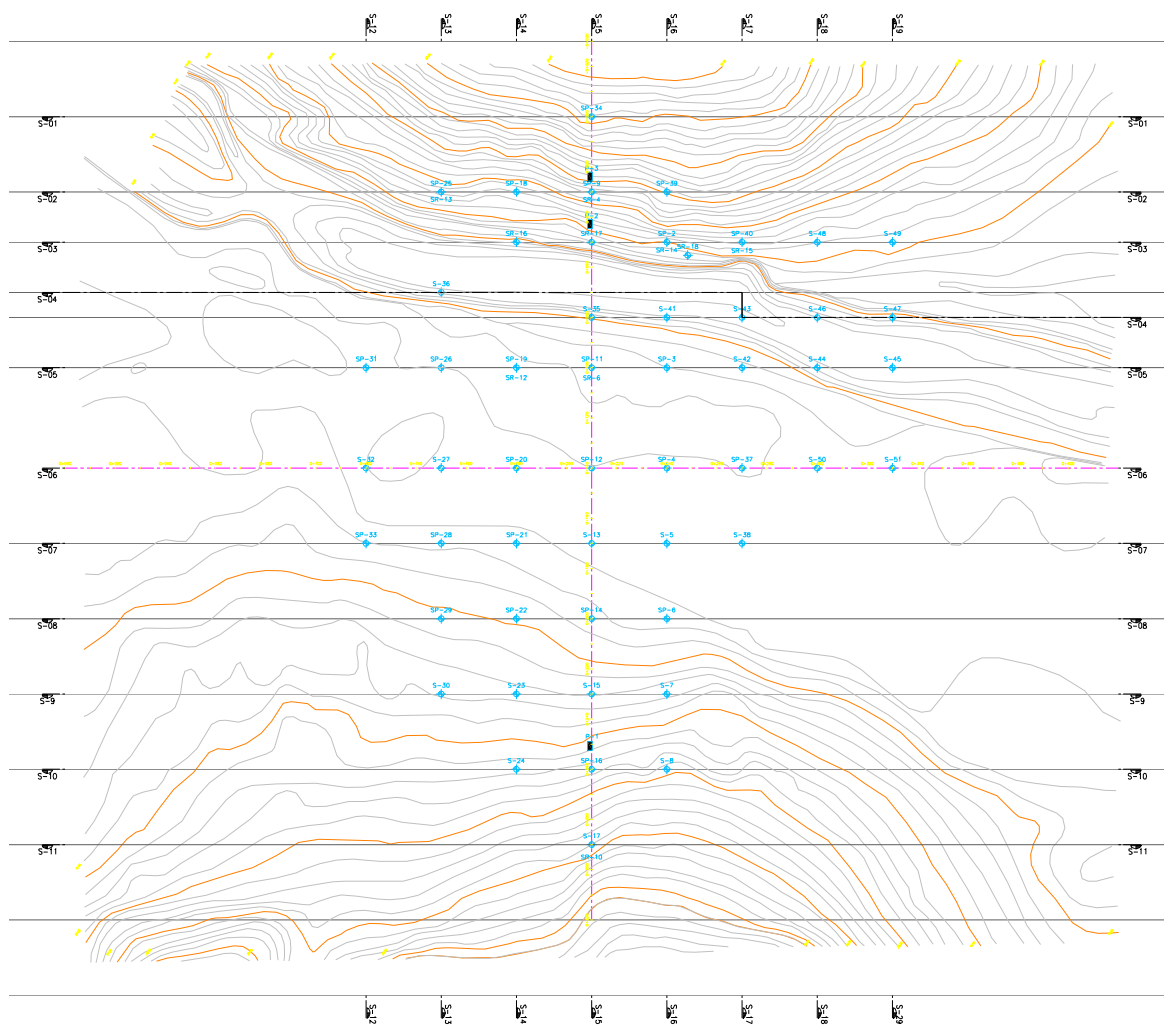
Localização das sondagens e das seções transversais e longitudinais
